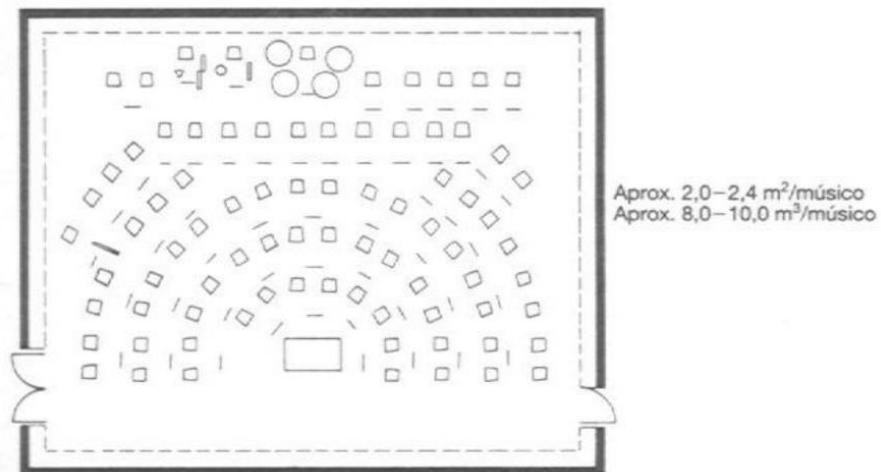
Sala de ensayo para orquesta. Planta tipo
